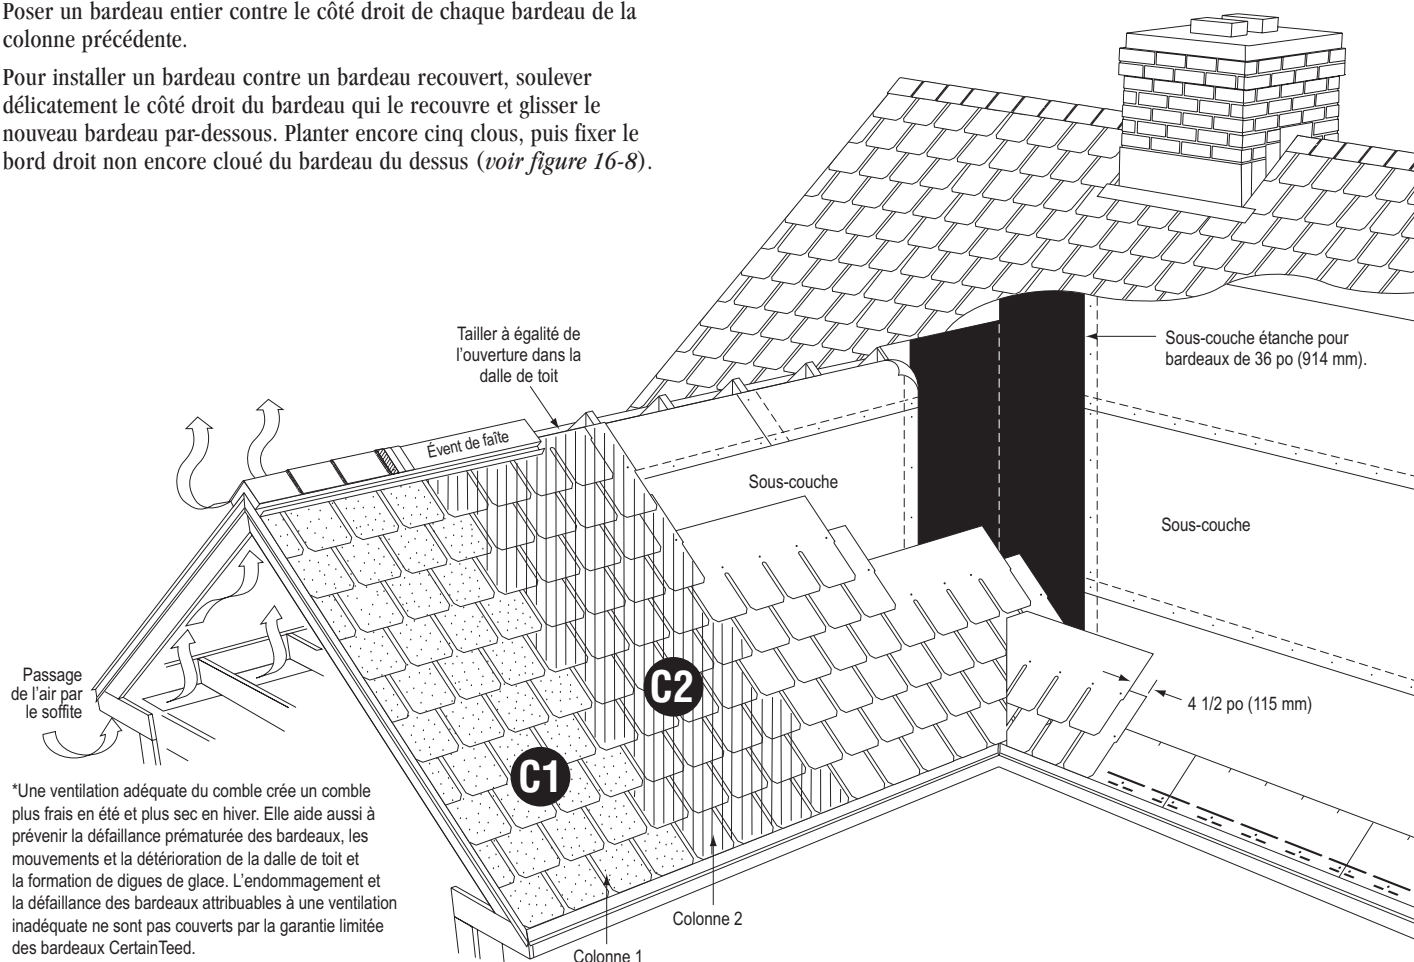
Schéma d'installation par « alignement vertical ».
